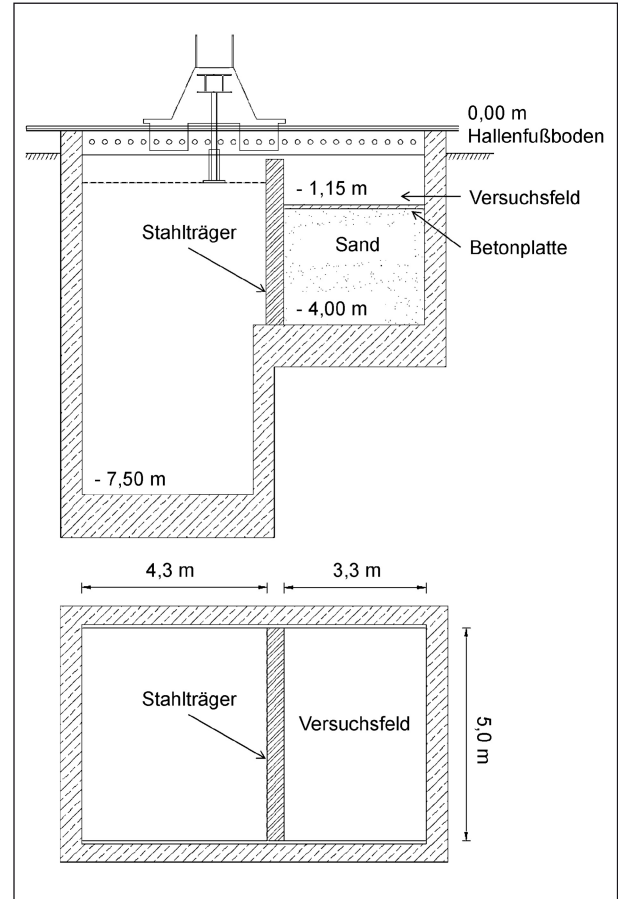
Darstellung der Versuchsgrube im Schnitt und im Grundriss
